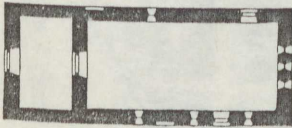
Gebersdorf; Kirche, ursprünglicher Grundriss. 1 : 500.
